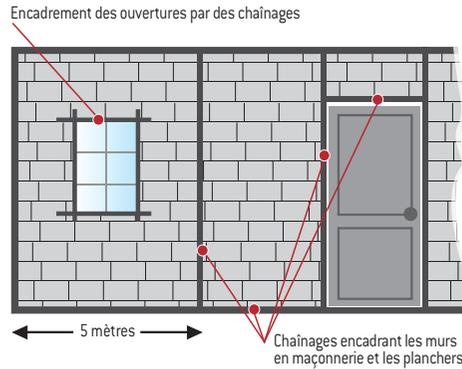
Ajout de chaînages horizontaux et verticaux encadrant les maçonneries (élévation)
